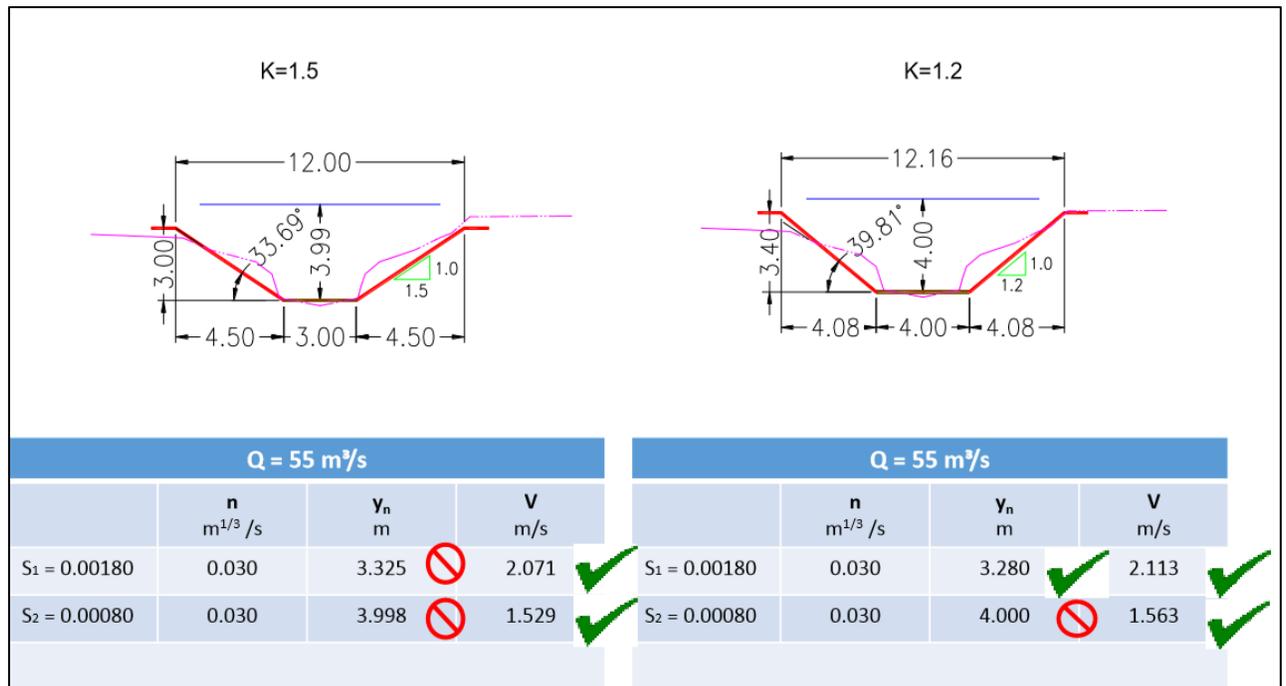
Opción 2 Sección de mampostería con fondo móvil (terreno natural).
